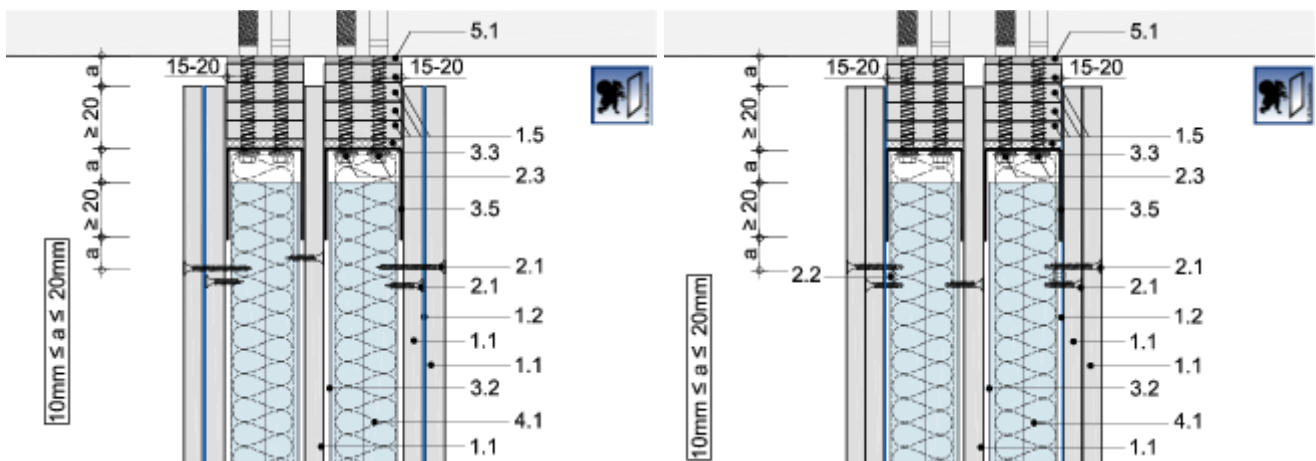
Gleitender Deckenanschluss Einfachständerwand RC 2
